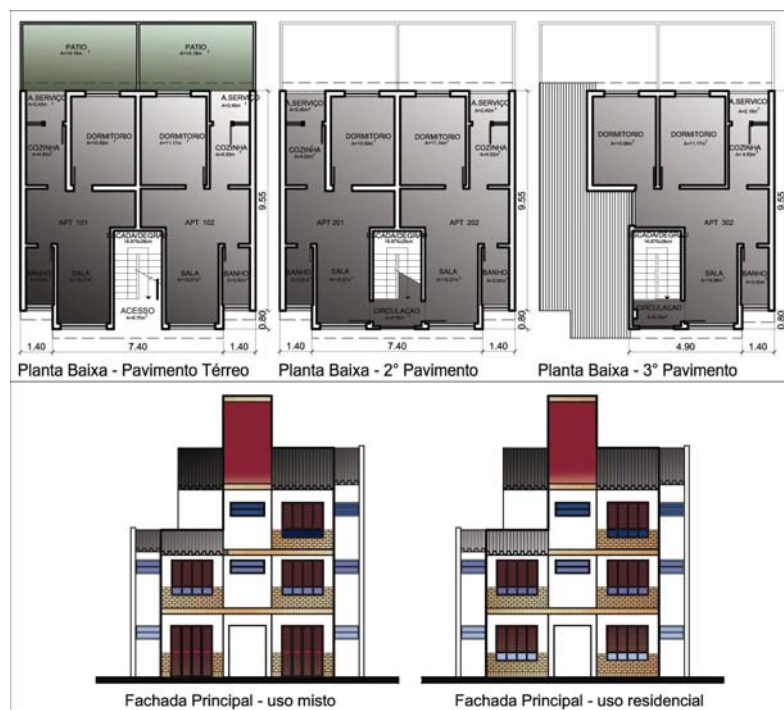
Planta baixa e Fachada do bloco tipo do Condomínio dos Anjos
